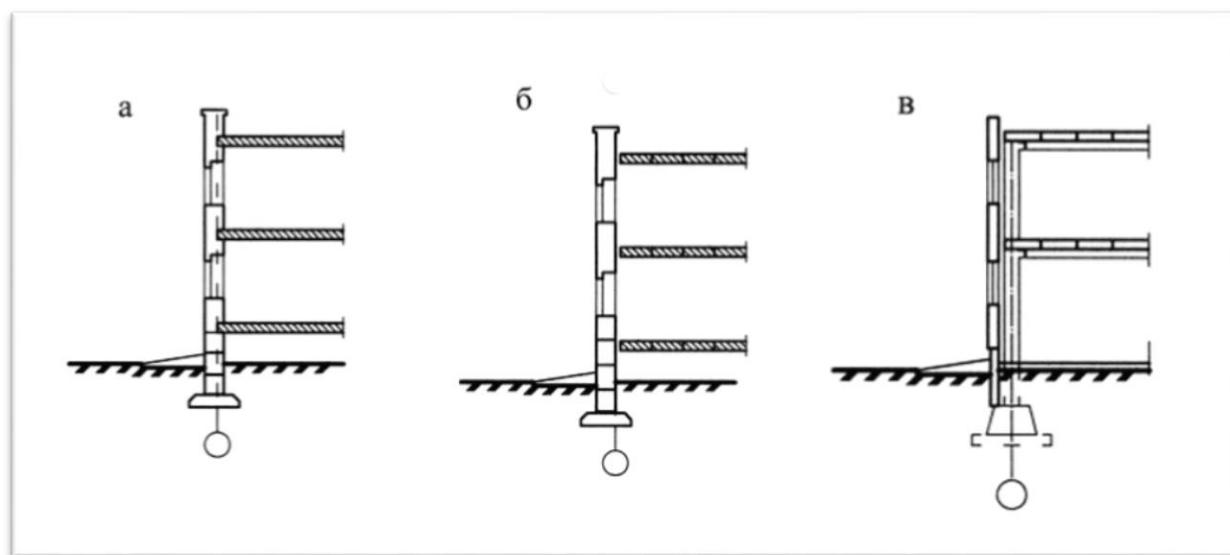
Типы стен: а – несущая стена; б – самонесущая стена;
